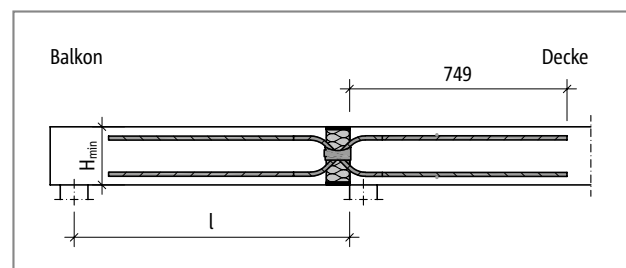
Schöck Isokorb® T Typ QP-VV7 und QP-VV9: Statisches System
